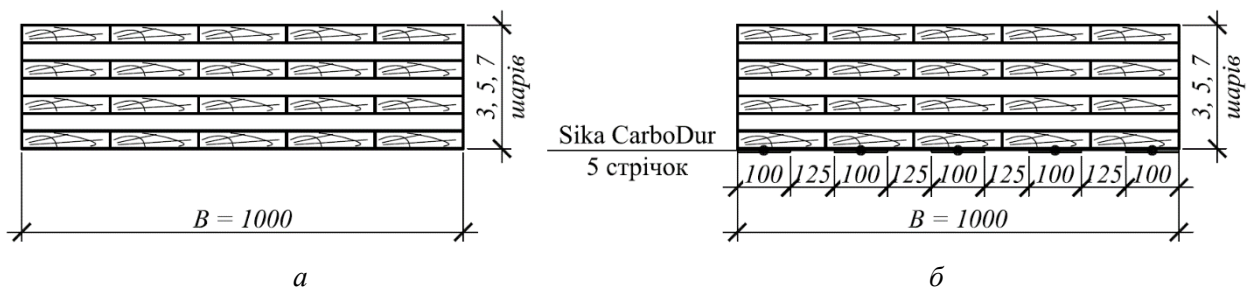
Геометрична схема поперечного перерізу плит з перехресно-клеєної деревини:
